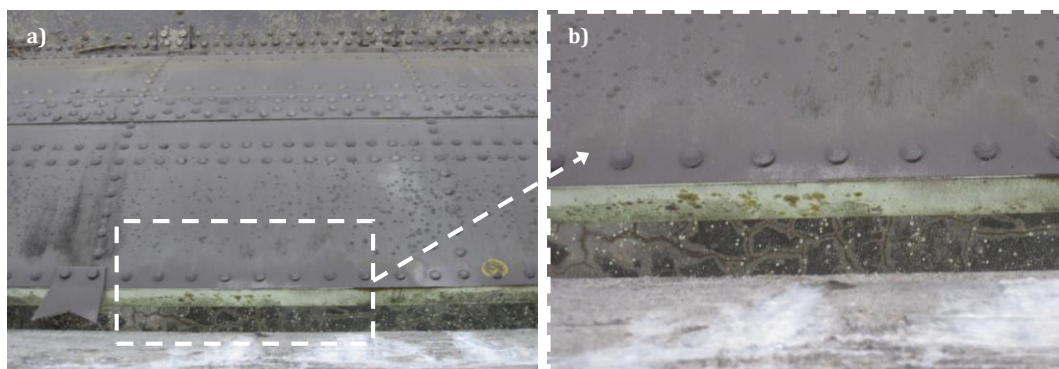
Fisuración enramada en el aliviadero: a) vista en planta; b) detalle
